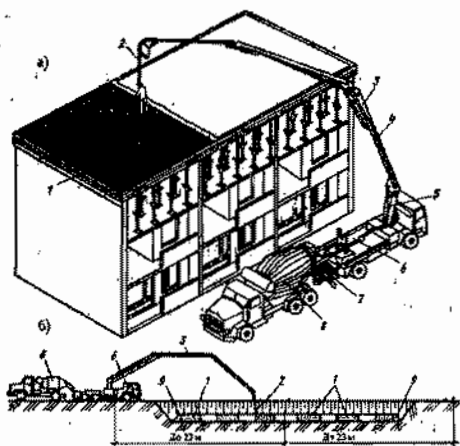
Укладка бетонной смеси автобетононасосами: 1 - укладка бетона; 2 - рукав; 3 - шарнирная стрела; 4 - бетоновод; 5 - гидроцилиндр; 6 - автобетононасос; 7 - приемный бункер; 8 - автобетоносмеситель; 9 - опалубка
